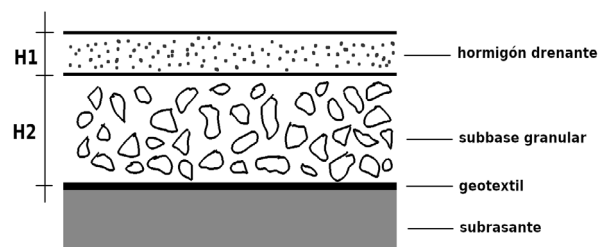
Perfil típico de un pavimento de hormigón poroso (elaboración propia)
